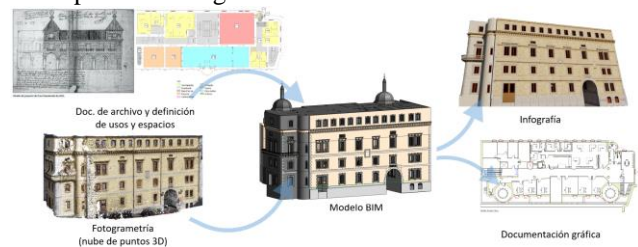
Levantamiento arquitectónico BIM del Ayuntamiento de Hernani.
